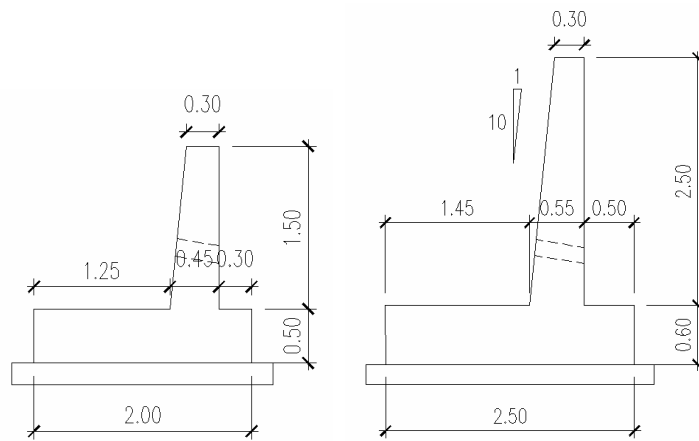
TIPO 1 e TIPO 2: sezione trasversale muri
